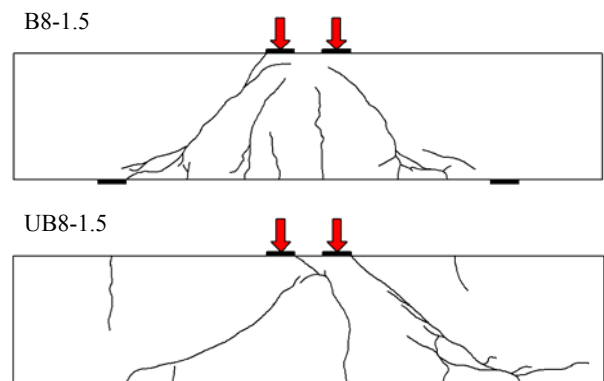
ひび割れの進展状況 ($a/d=1.5$)
